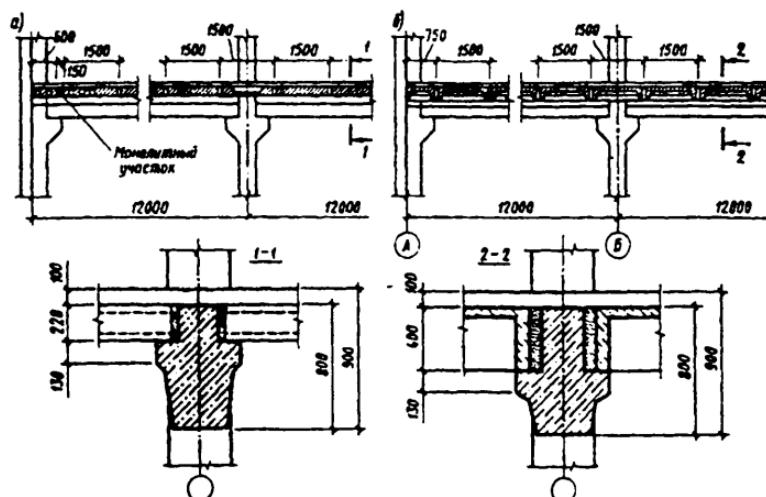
Каркас многоэтажных зданий с пролетами 12×12 м:
